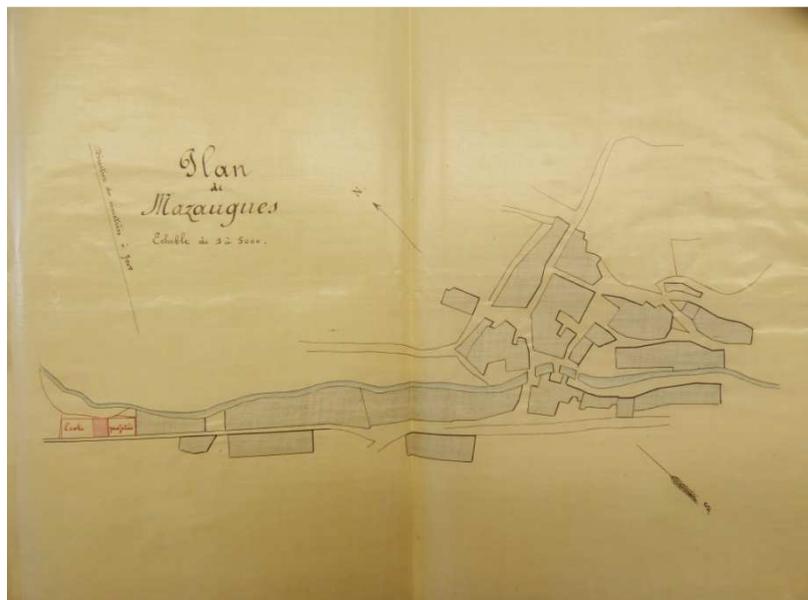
Projet de construction d'une maison d'école avec mairie, plan de Mazaugues, Angeli (conducteur des Ponts et Chaussées).
